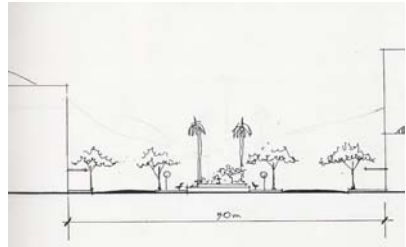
Corte transversal da Avenida no 2º período* – surgimento das palmeiras nos canteiros centrais.
